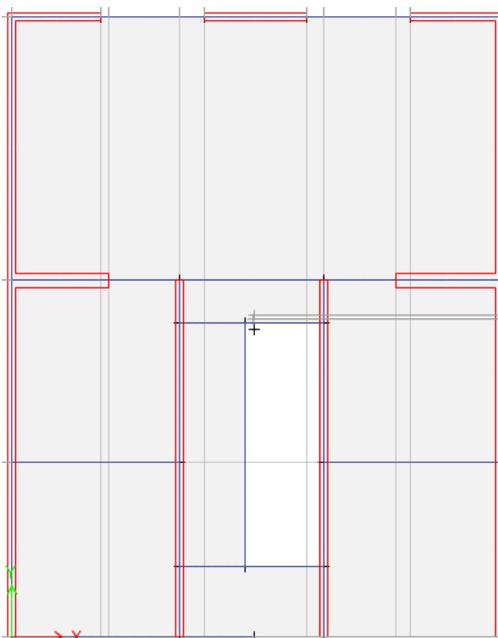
Planta típica diseño industrial del modelamiento en ETABS.
